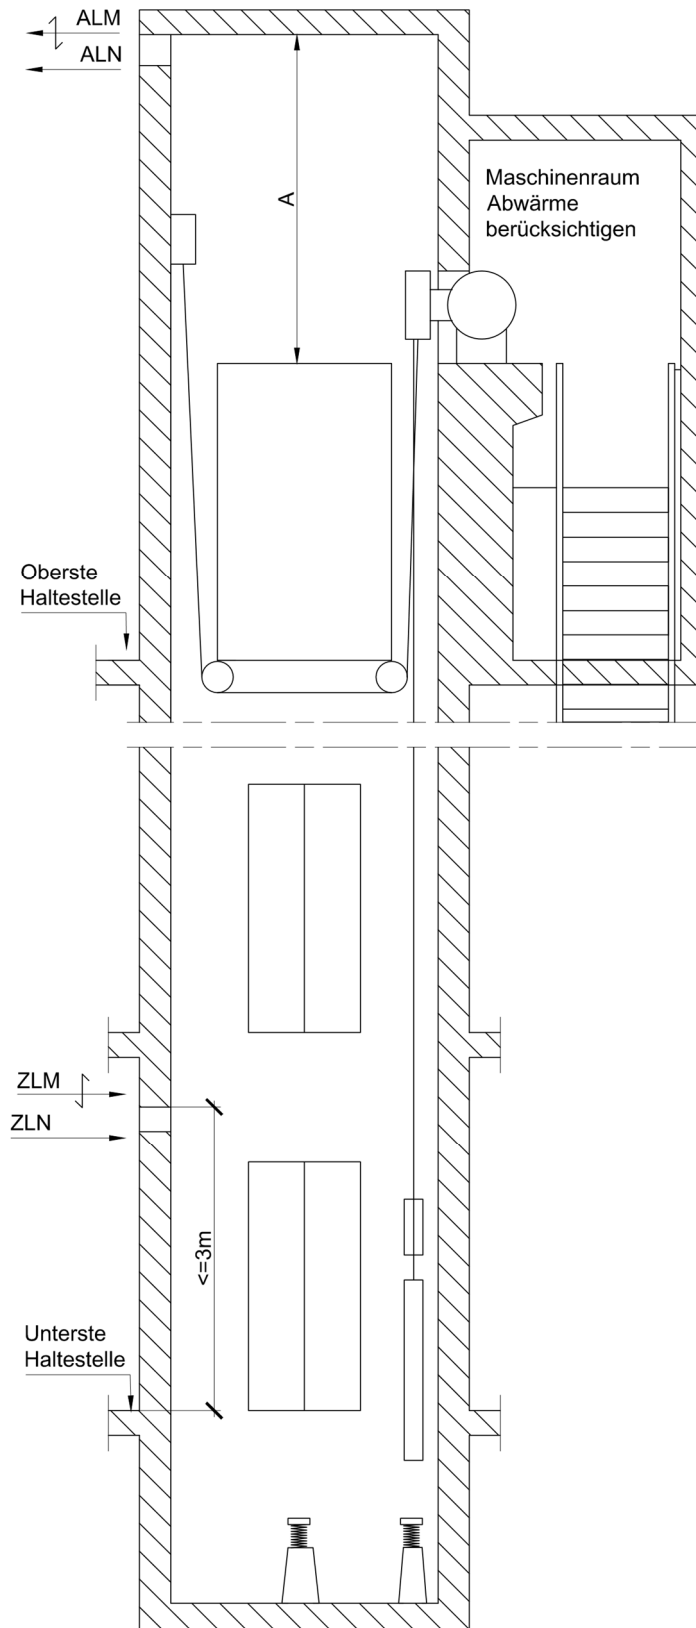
Aufzug mit Maschinenraum oben seitlich neben dem Schacht
